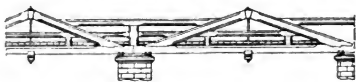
bis 204. Hängewerksbrücke mit zwei Hängesäulen. M. 1 : 170.
